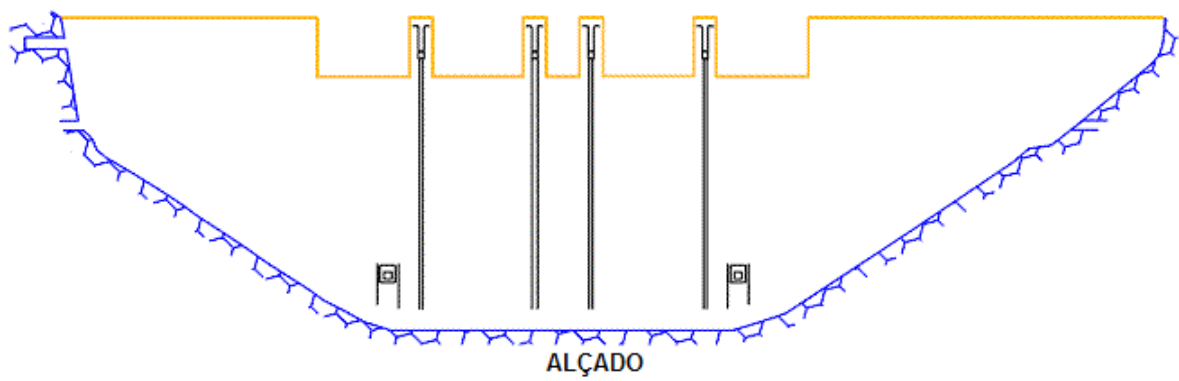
Barragem de Bemposta – Alçado [4]
